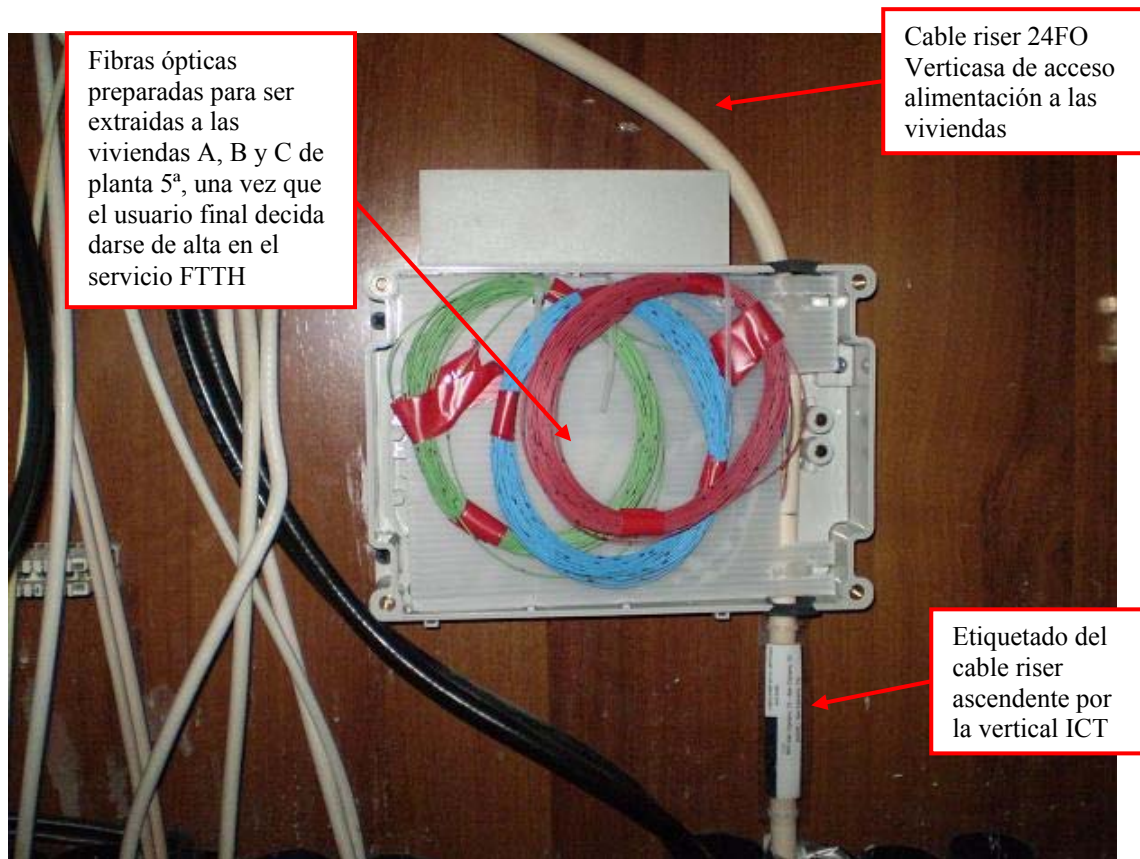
Vista exterior de caja Riser Box Verticasa, de derivación de planta 1ª
